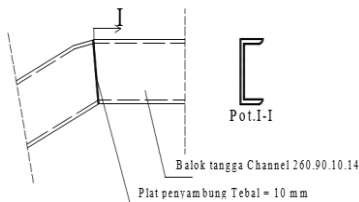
8 Sambungan balok bordes dengan balok penumpu bordes
